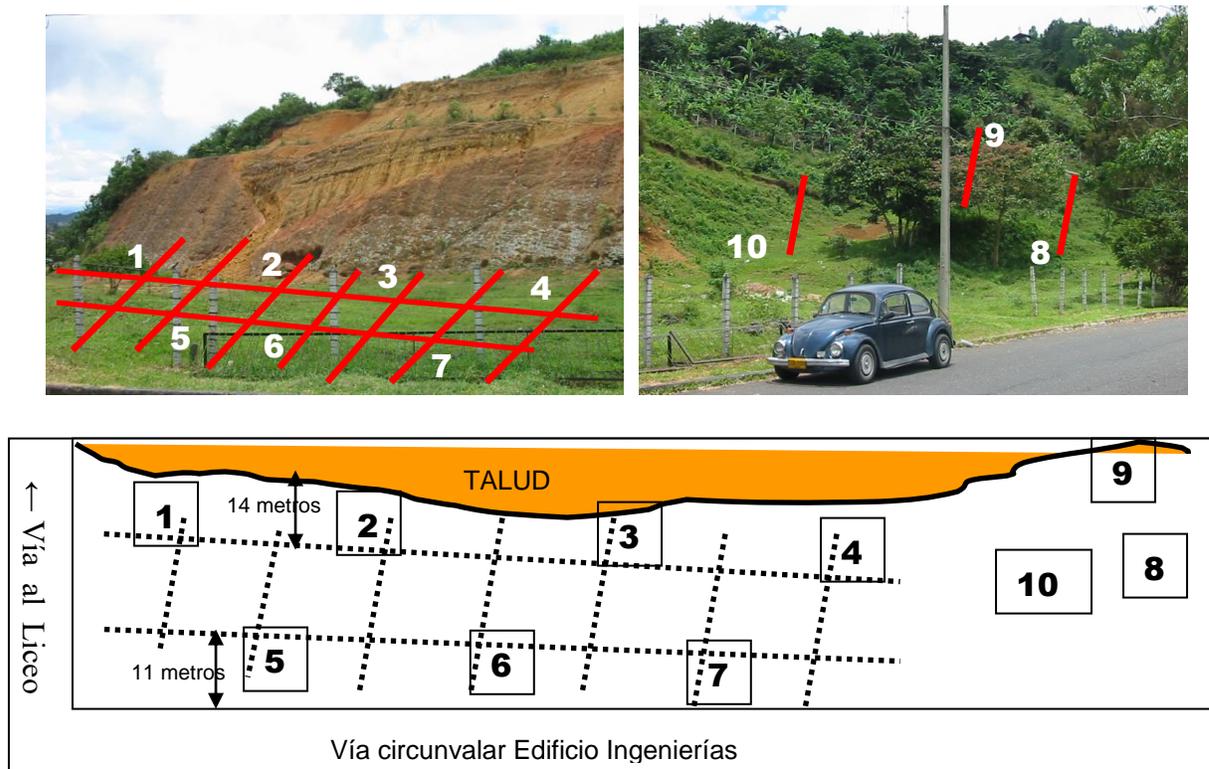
Ubicación en planta de los sondeos (Tomado del Estudio de Suelos y Recomendaciones de Cimentación)
